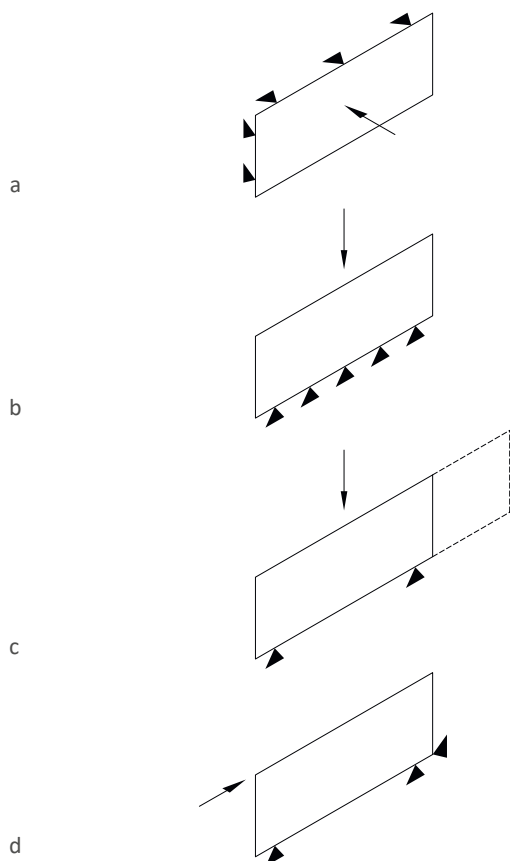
Prinzipielle statische Beanspruchungen und Auflagerreaktionen eines BSP-Wandbauteils
